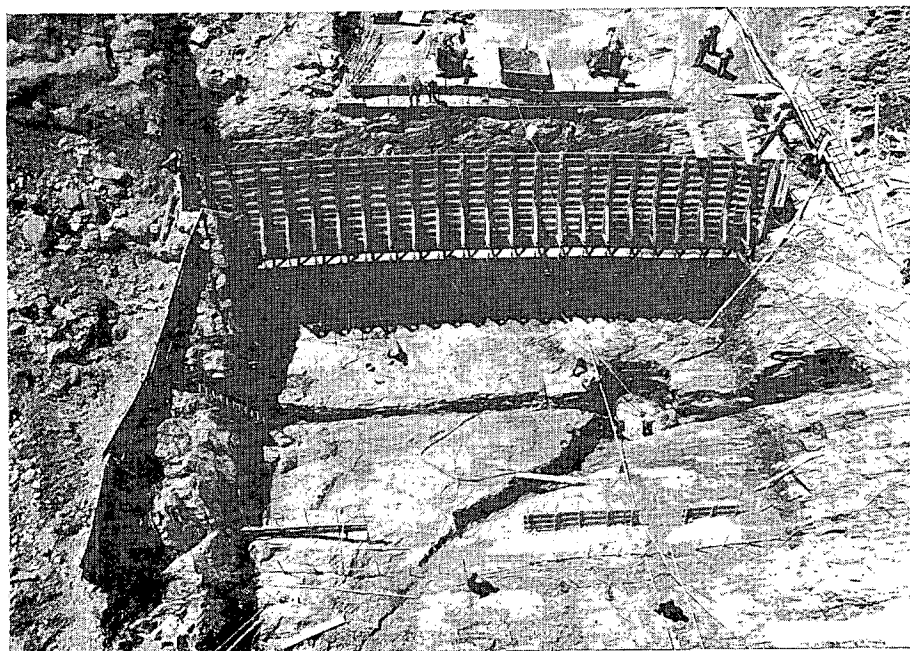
Preparación de la roca de cimentación del bloque central. Pueden observarse las zanjas de saneo de las fallas "Mateo" y "Weyerman II". Hormigonado del muro espaldón de anclajes de precompresión de la falla "Weyerman I".
